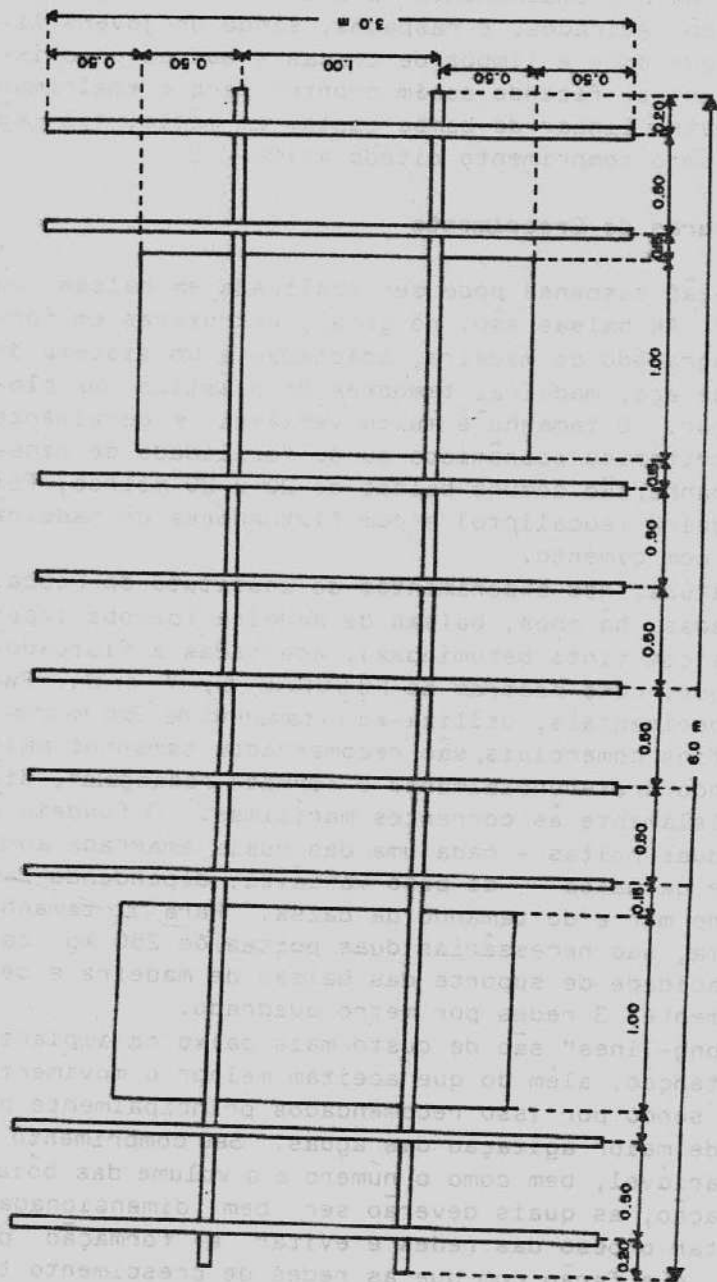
Planta baixa de uma balsa de crescimento (3 x 6m). Escala 1:25.
